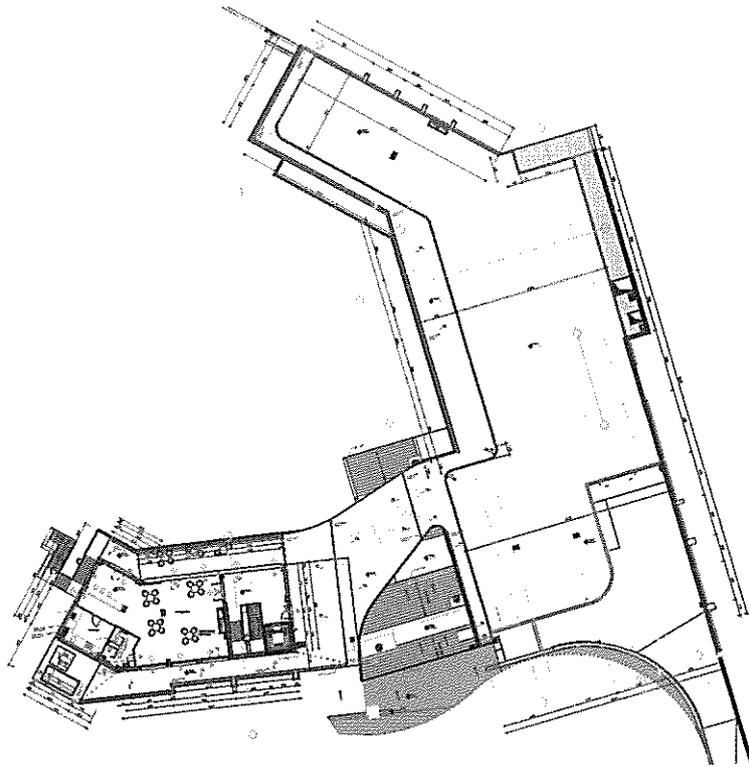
Planimetri dhe pamje te objektit "Palazzina"
